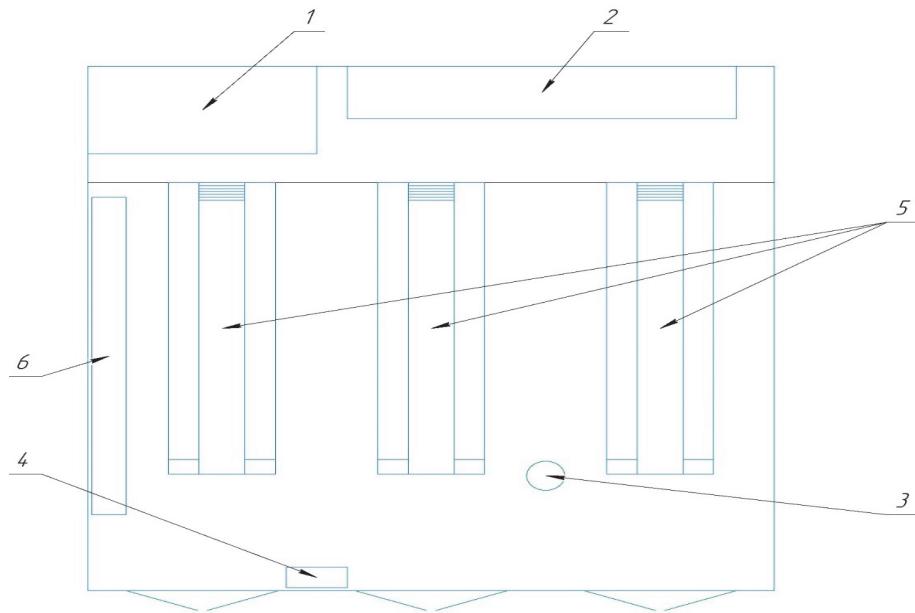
Схема производственного помещения: 1 – комната отдыха; 2 – зона хранения инструмента и вспомогательного оборудования; 3 – сверлильный станок; 4 – сварочный пост; 5 – смотровая яма; 6 – зона хранения автомобильных смазочных материалов
